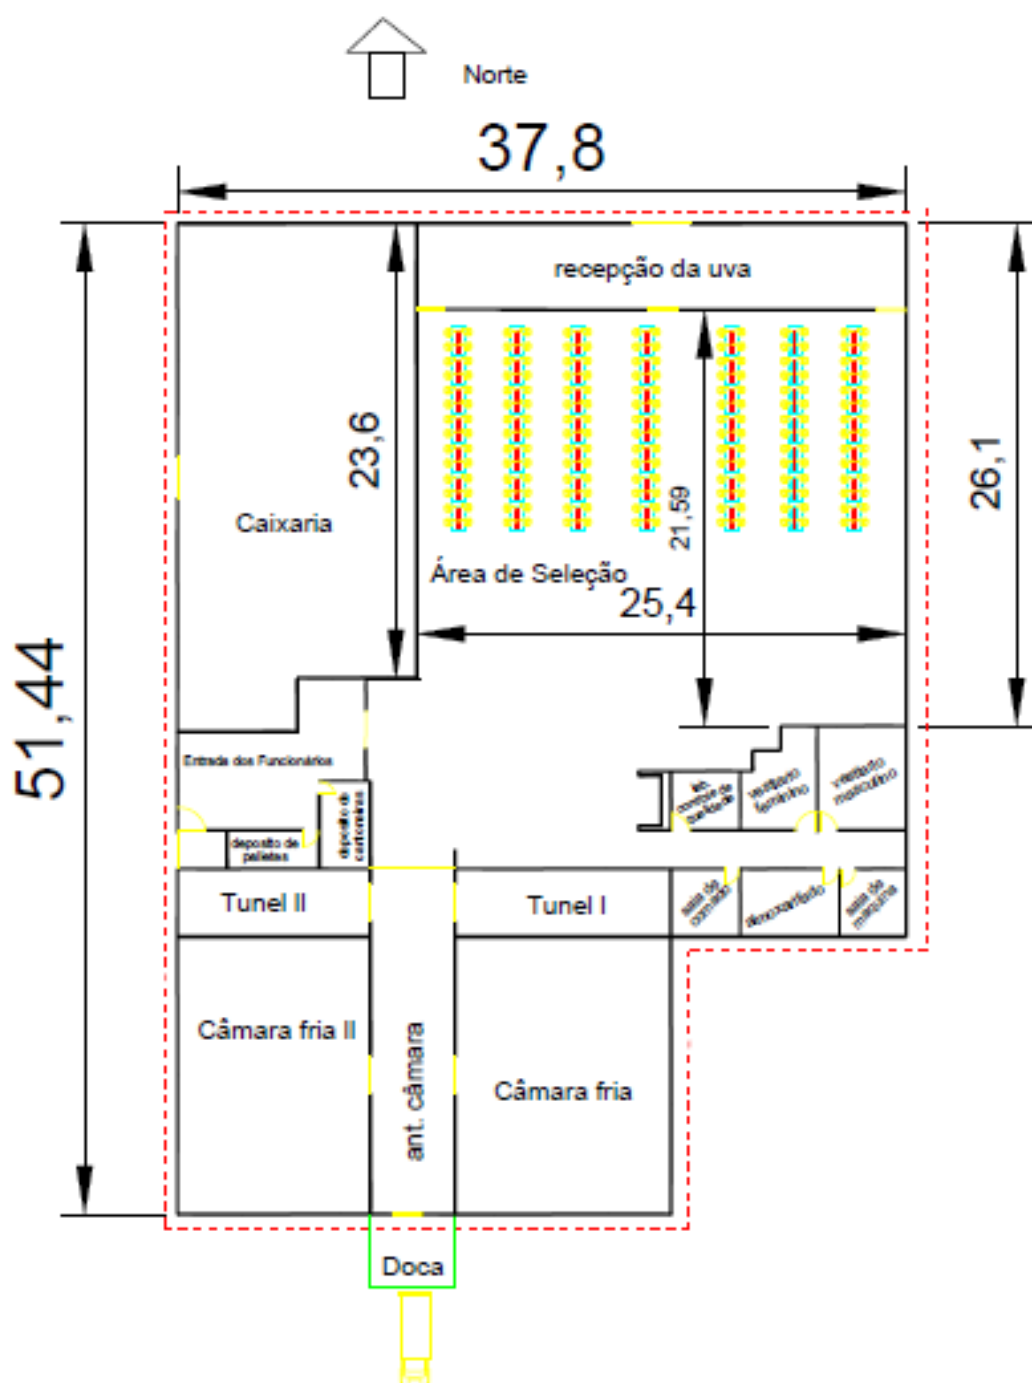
Planta Baixa do *packing house* da Frutos do Sol
